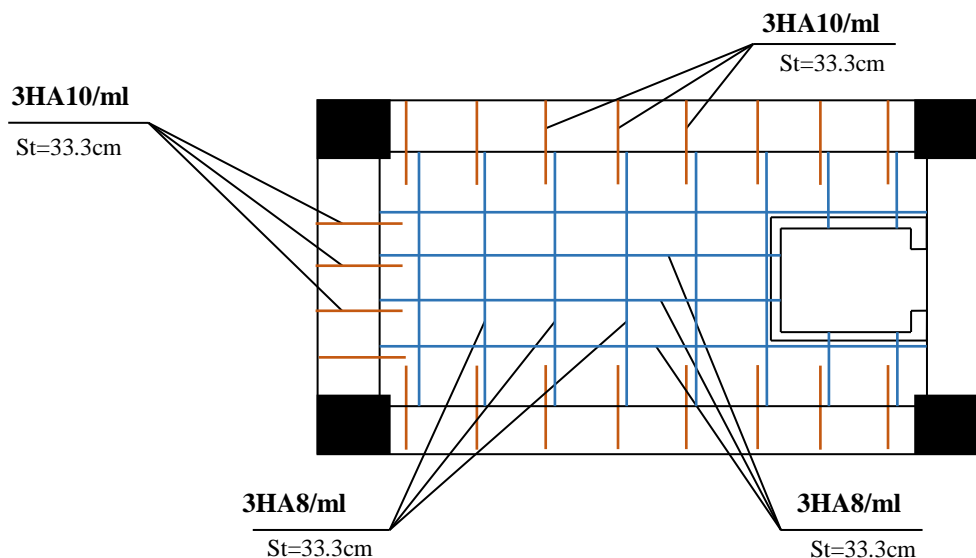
Schéma de ferrailage de panneau de dalle D8
